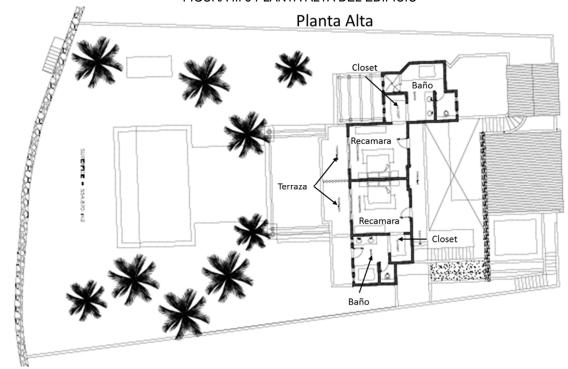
PLANTA ALTA DEL EDIFICIO
